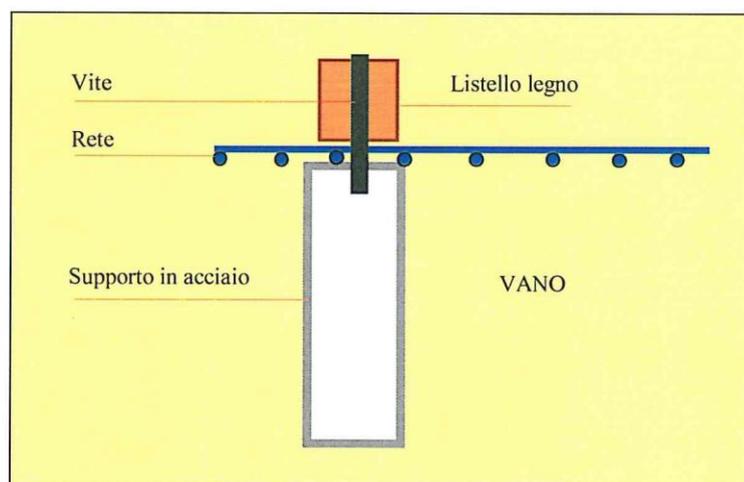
Sezione schema di posa delle reti “First” sottoposte a prova
